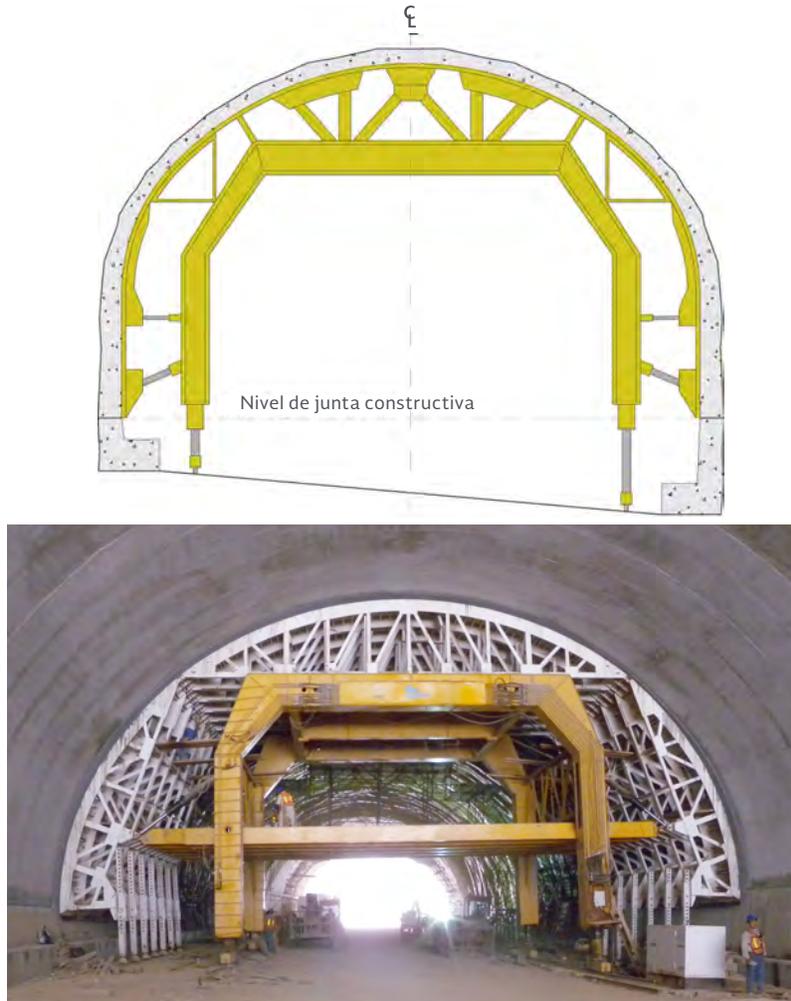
Esquema de una cimbra en calzada inclinada, manteniendo el nivel de la junta constructiva.
